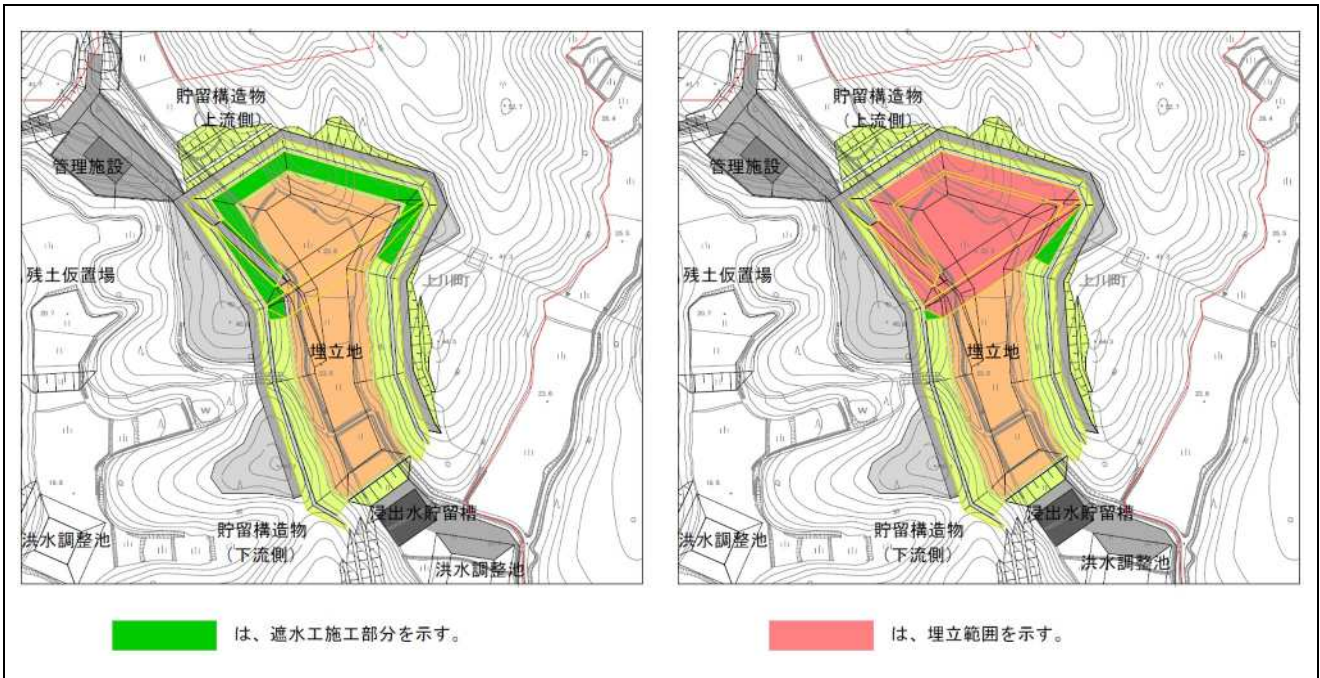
(2) 埋立計画平面図 (第 2 期)
